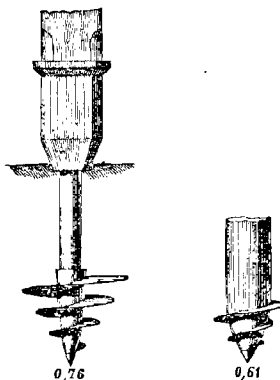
Vis et sabot en fonte réunis par une tige en fer, pour porter un pieu de bois (457 kil.)
